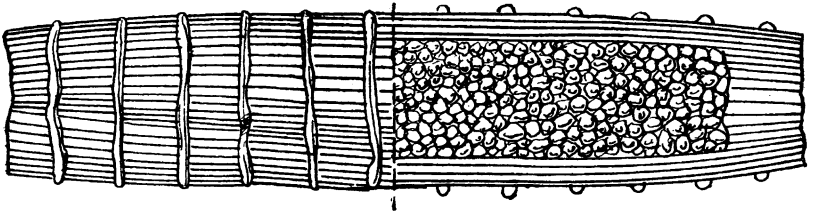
Ansicht und Längsschnitt einer Senfmaschine.
